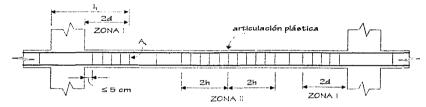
Requisitos para refuerzo transversal en vigas
